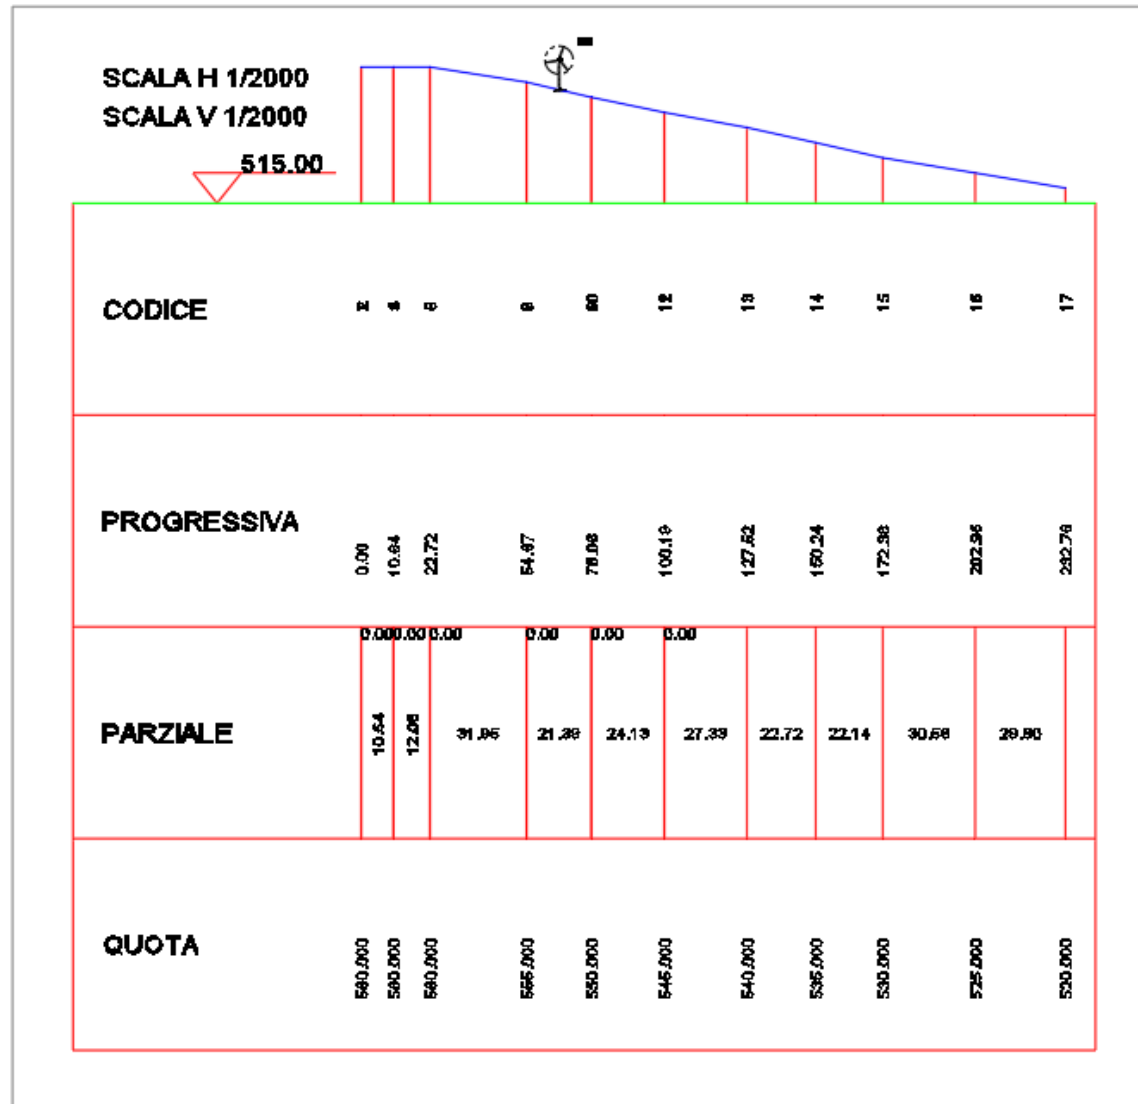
Profilo Sezione D-D' e ubicazione generatore di progetto BV4
